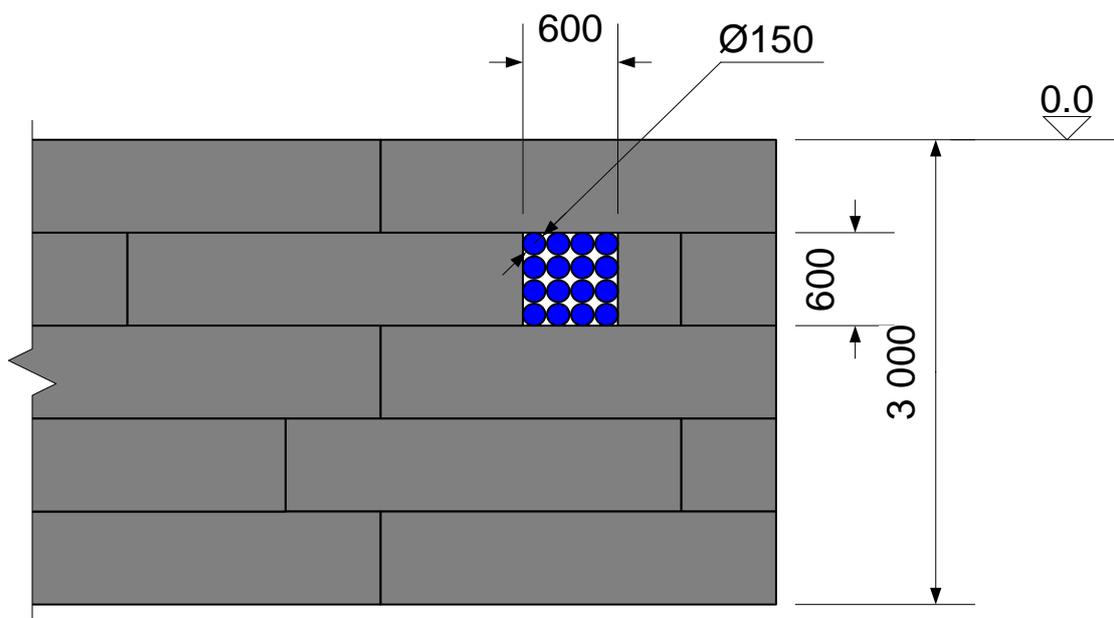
Вывод КЛ-10 кВ через фундамент здания подстанции
